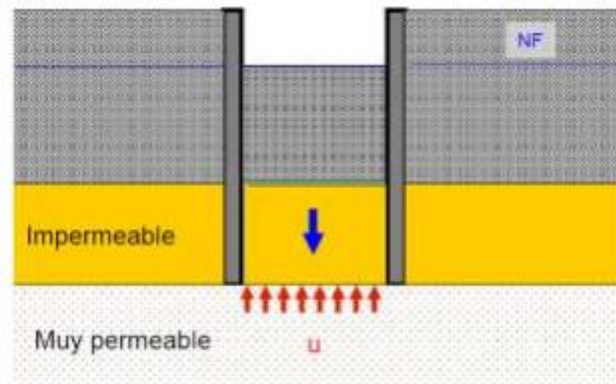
Levantamiento de fondo. (Fuente: Materia de diseño geotécnico de cimentaciones y muros de contención)
